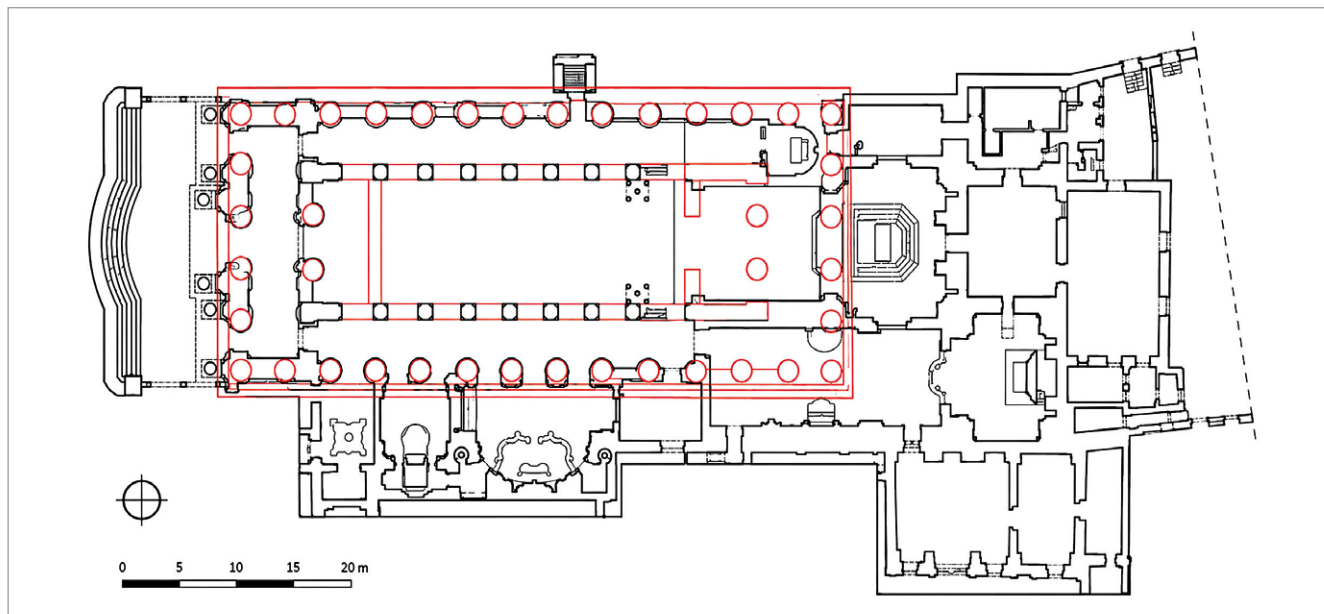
Siracusa, cattedrale/*Athenaion*: planimetria (da SGARIGLIA 2009).
